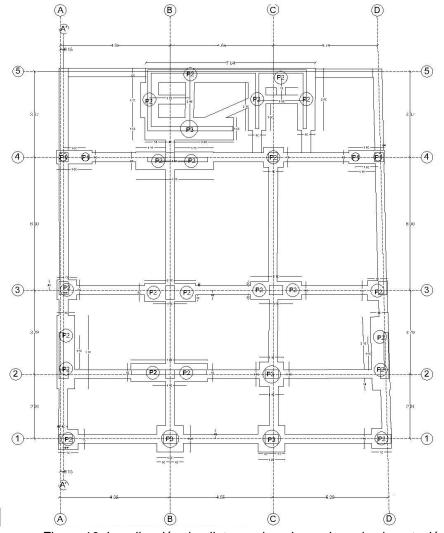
Localización de pilotes, cabezales y vigas de cimentación.
